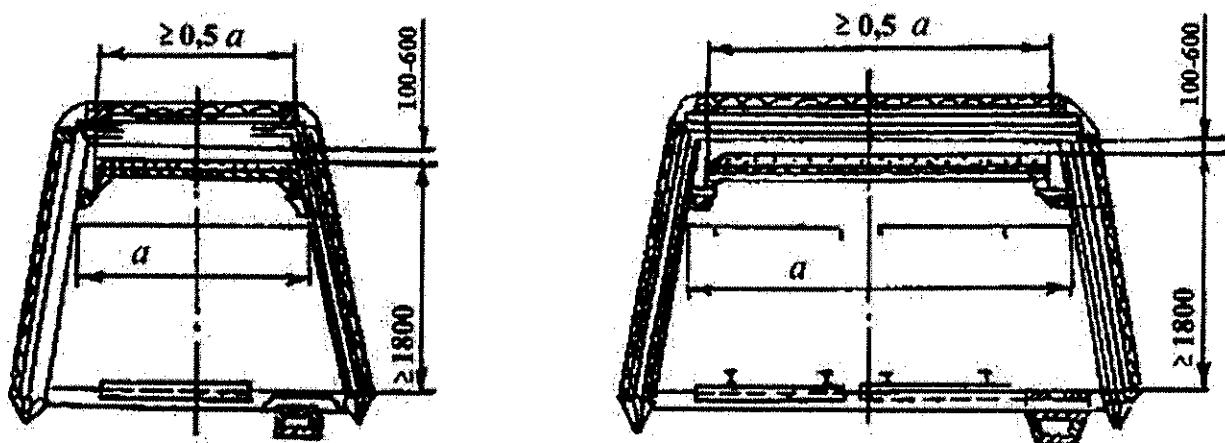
Схема установки сланцевых заслонов в выработках, закрепленных железобетонными стойками и шарниро-подвесными верхняками
